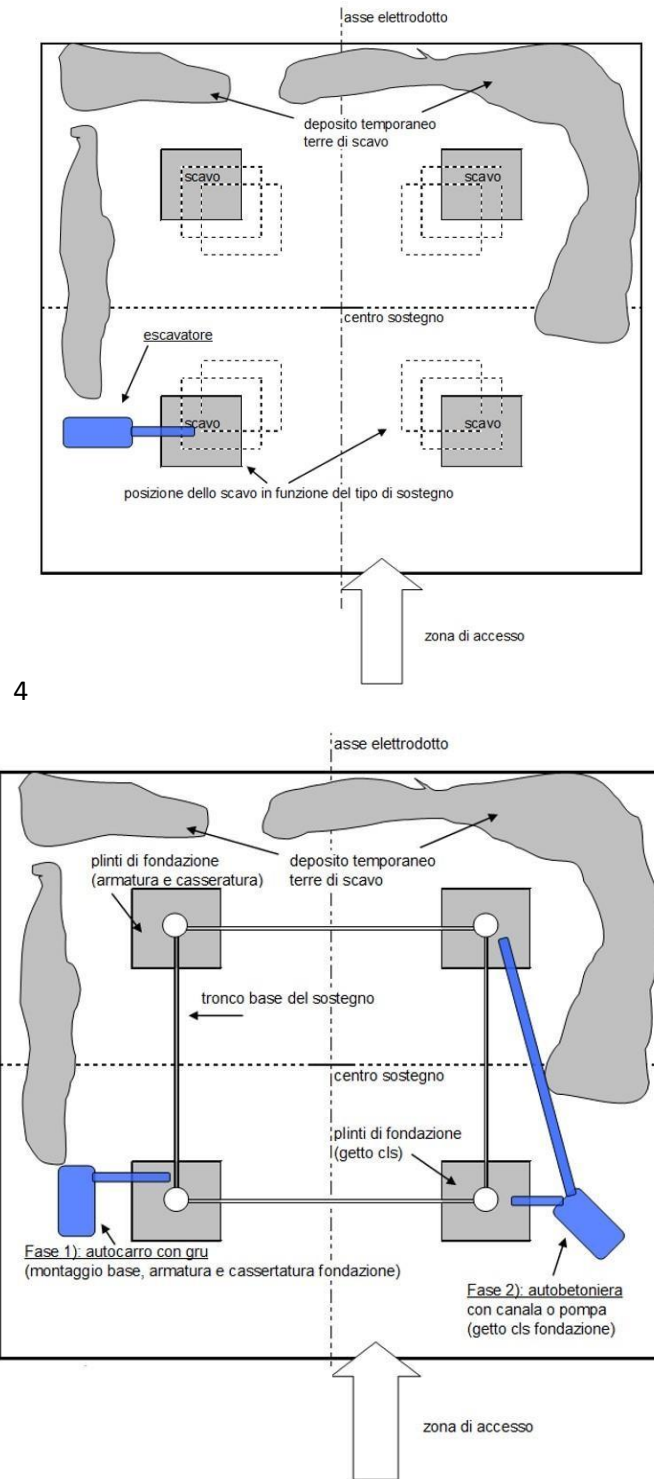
Planimetria dell'Area Sostegno (scavo di fondazione - getto e basi) – Tipologico
